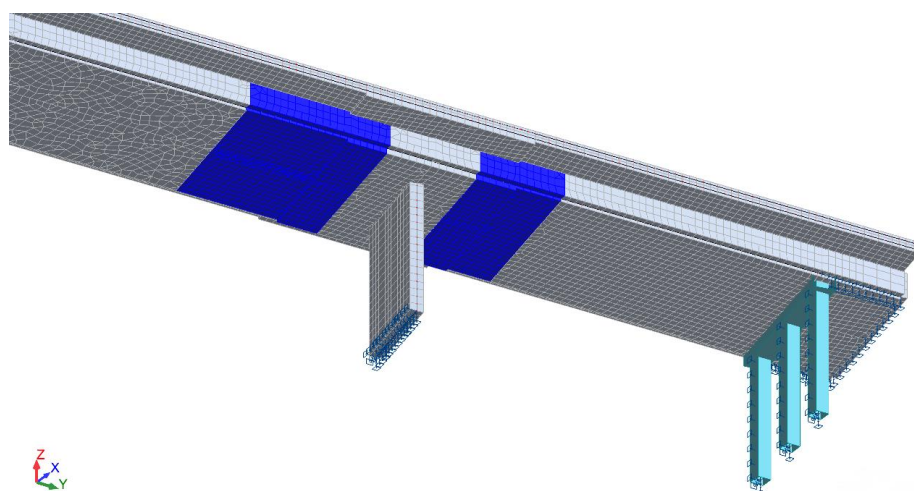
Secções do modelo onde foi aplicada a redução do módulo de Young para simular os assentamentos do pilar
